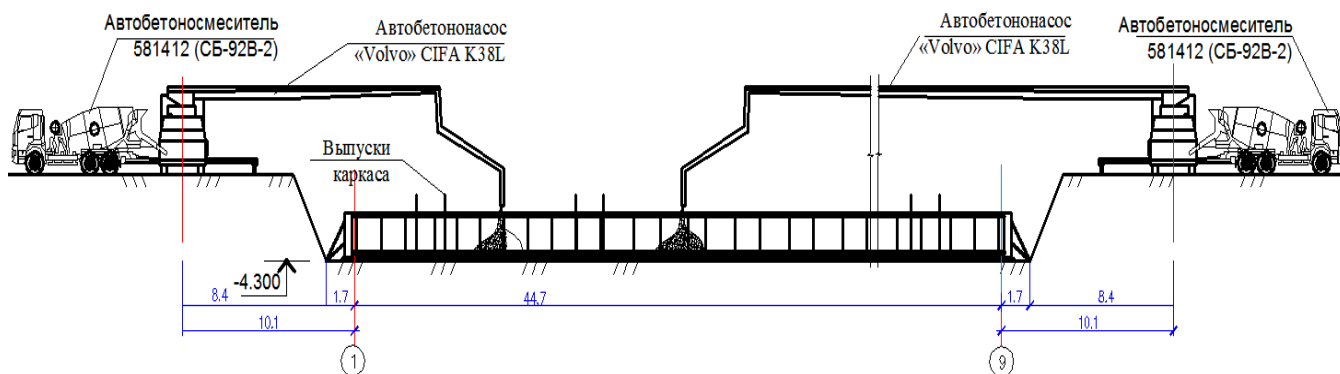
Подача бетона в конструкцию бетононасосом
